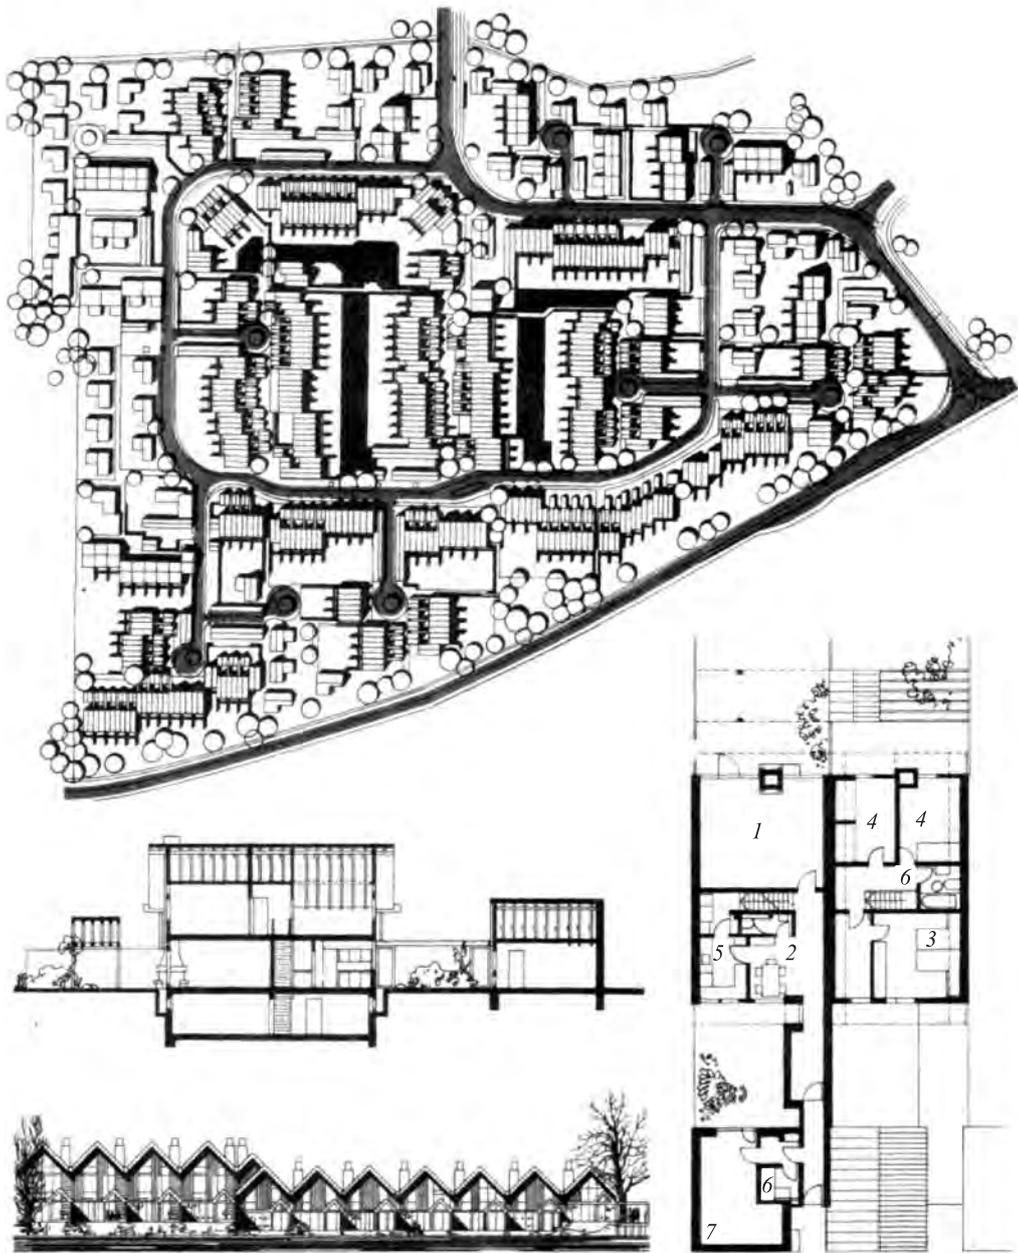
Блокированные дома с входами в квартиры через хозяйственные постройки (жилой комплекс, ФРГ). Генеральный план, разрез, общий вид застройки, план: 1 — общая комната; 2 — столовая; 3 — кухня; 4 — спальни; 5—7 — хозяйственные помещения, санузлы
